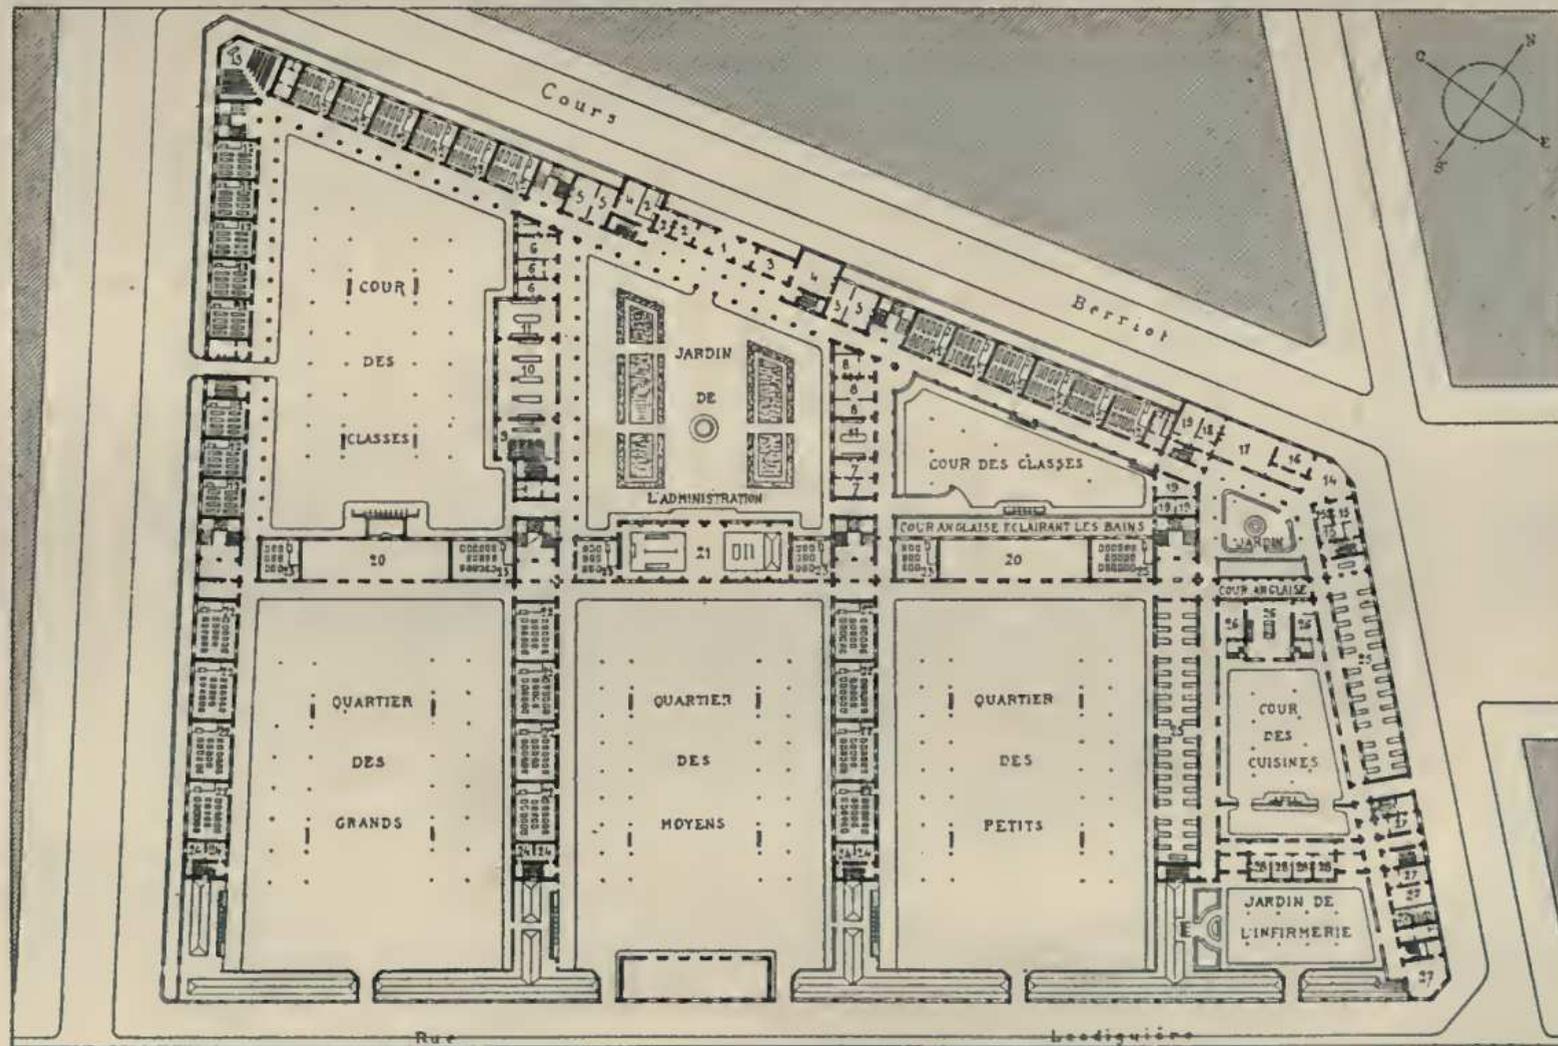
Lycée de Grenoble. Plan du rez-de-chaussée.
